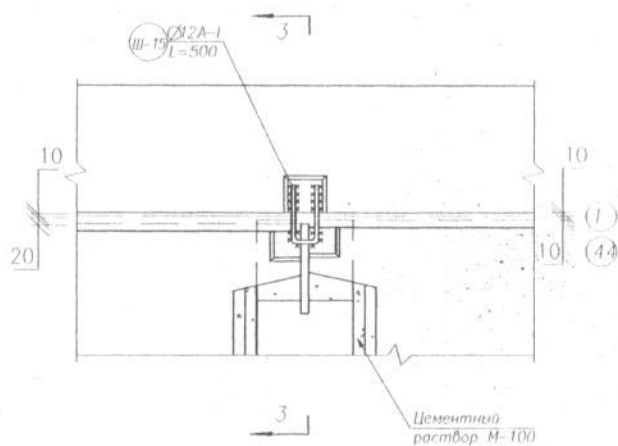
Стык внутренних перегородок и панелей перекрытия
